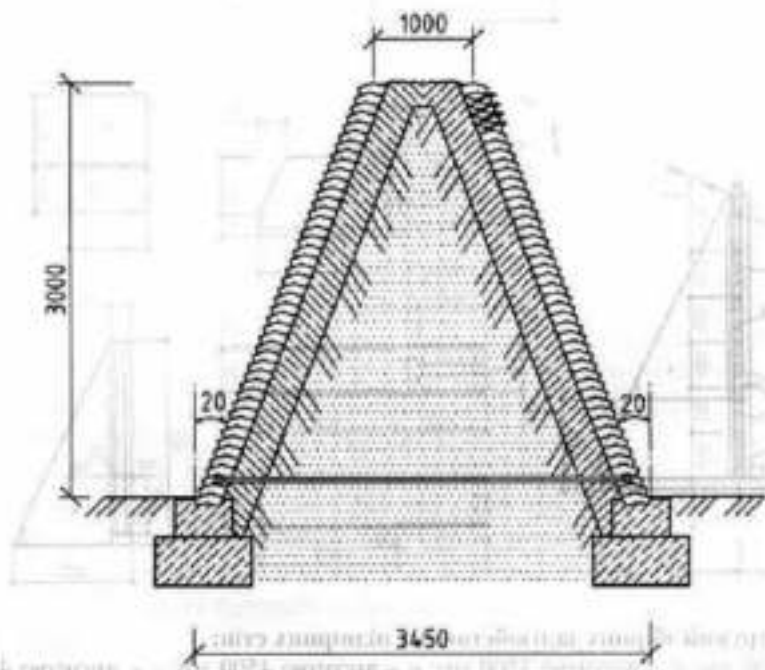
Розріз кавальєру, облицьованого бетонними елементами
